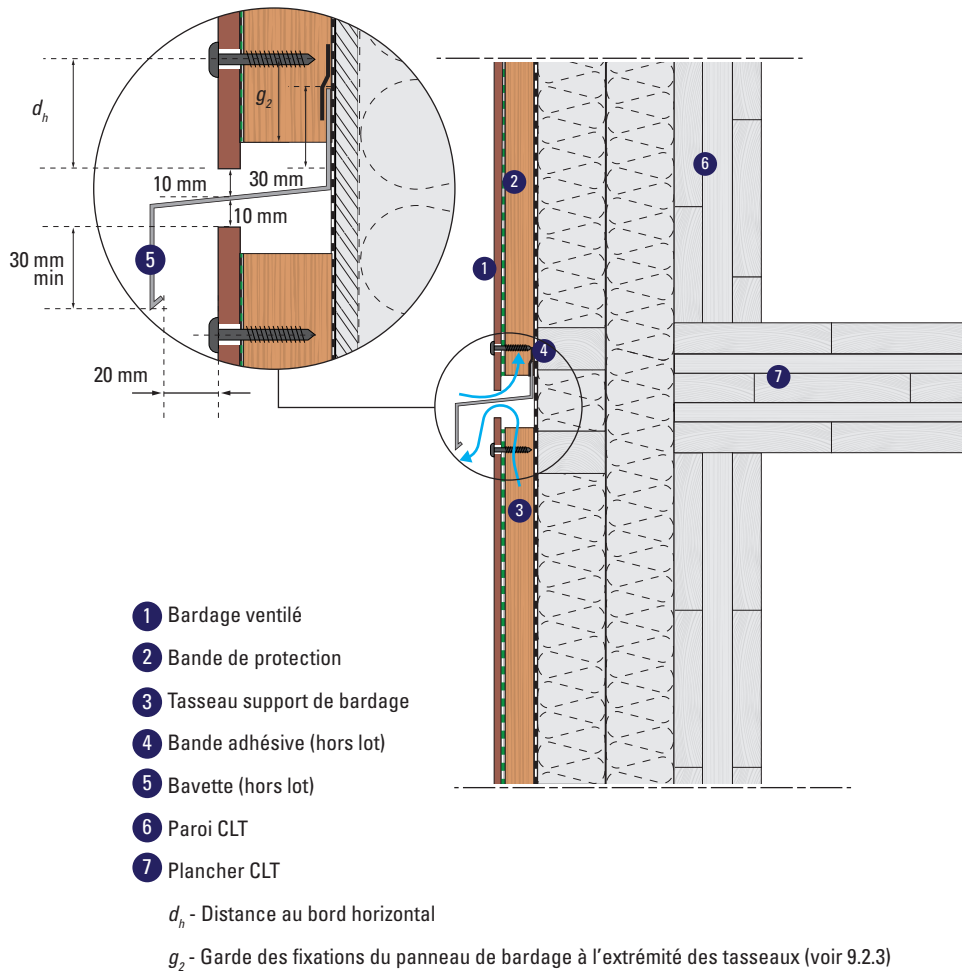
Exemple de recouvrement de lame d'air : paroi CLT au droit d'un plancher CLT (joints fermés) - coupe verticale
